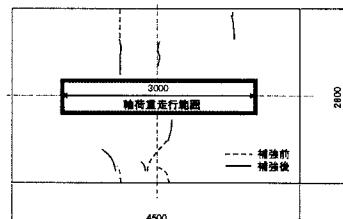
補強後(走行回数400万回時)の床版上面のひび割れ状況(単位:mm)
